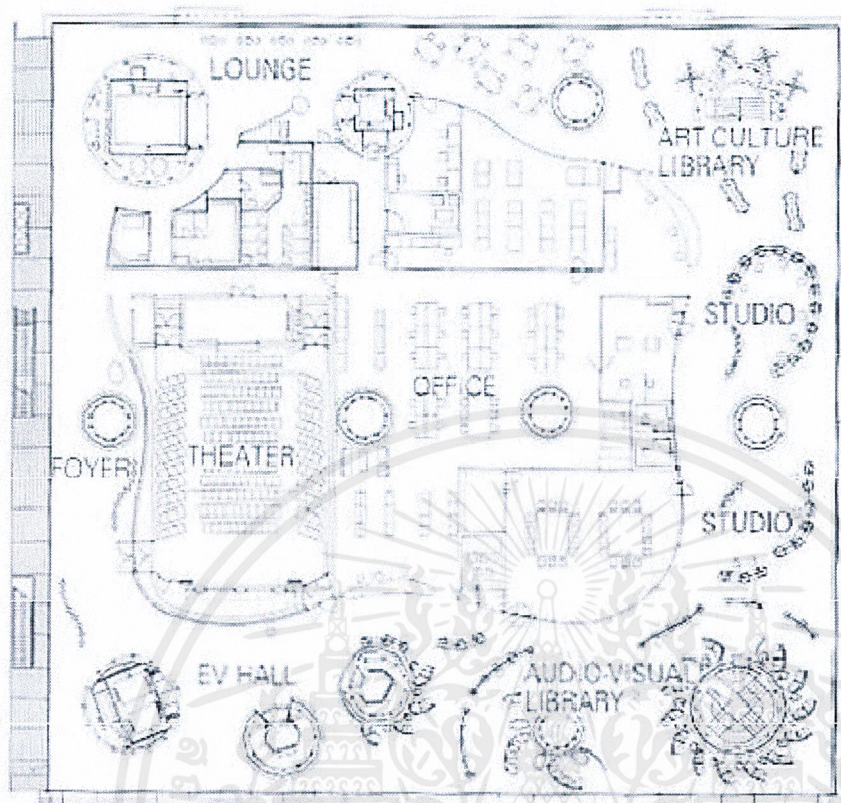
แสดงผังพื้นที่ชั้นที่ 6 (6th Floor Plan)
